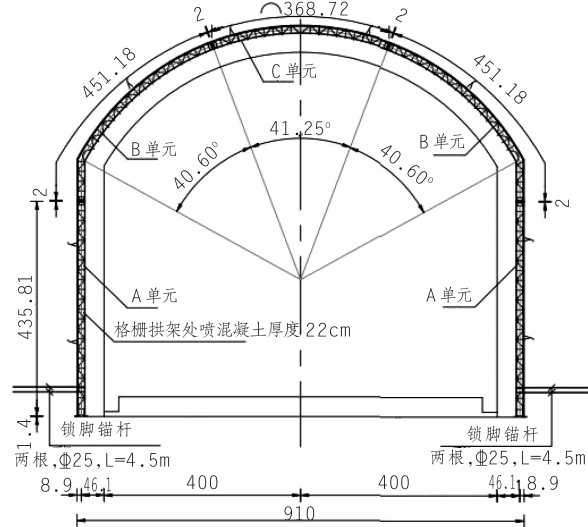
引水 1 号、5 号施工支洞Ⅳ类围岩钢筋格栅拱架安装设计图(单位:cm)
